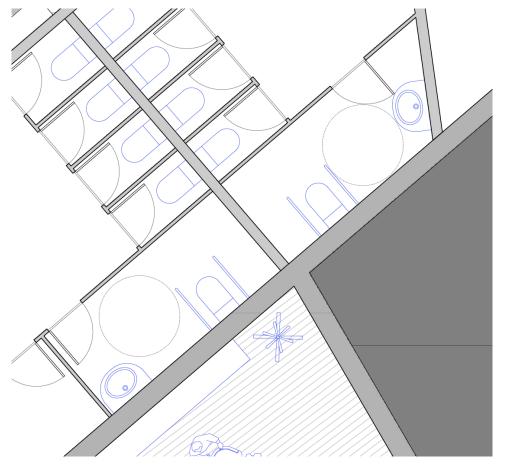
Baños accesibles para mujeres y hombres en Planta -1. Fuente: Elaboración propia.
